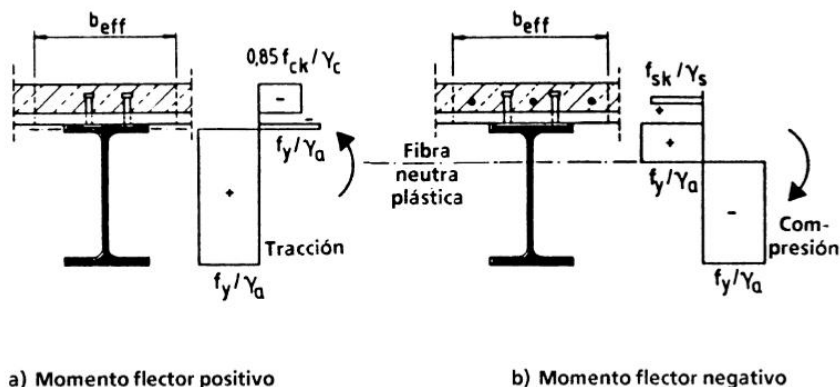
Distribución plástica de tensiones en una viga mixta de chapas de acero nervadas y conexión completa, con la fibra neutra situada en la sección de acero
